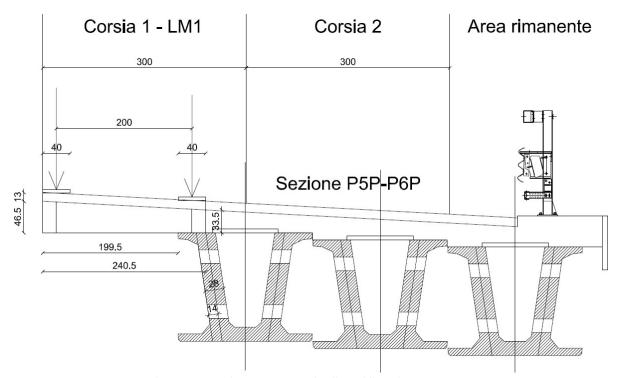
Sezione trasversale di verifica tipo F3
